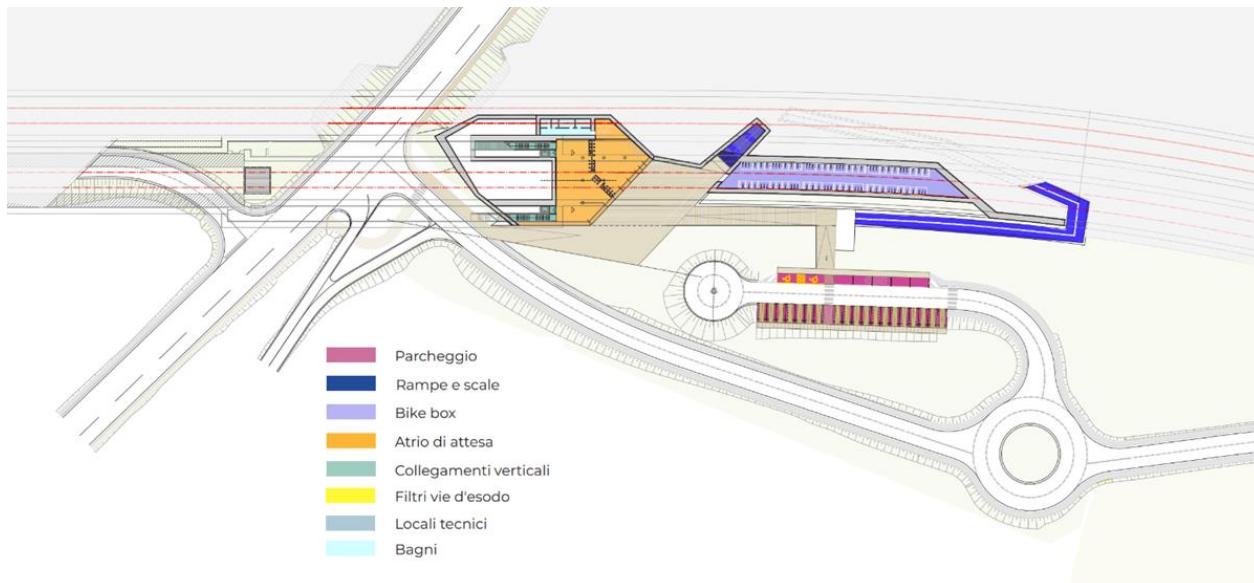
Progetto Fermata San Massimo – Pianta mezzanino
